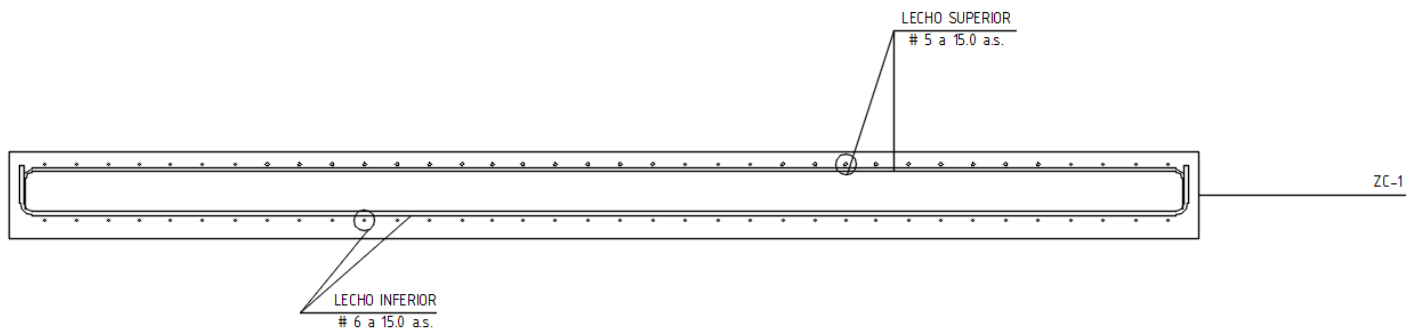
Plano de taller para zapata alargada Z - 1, sección longitudinal
